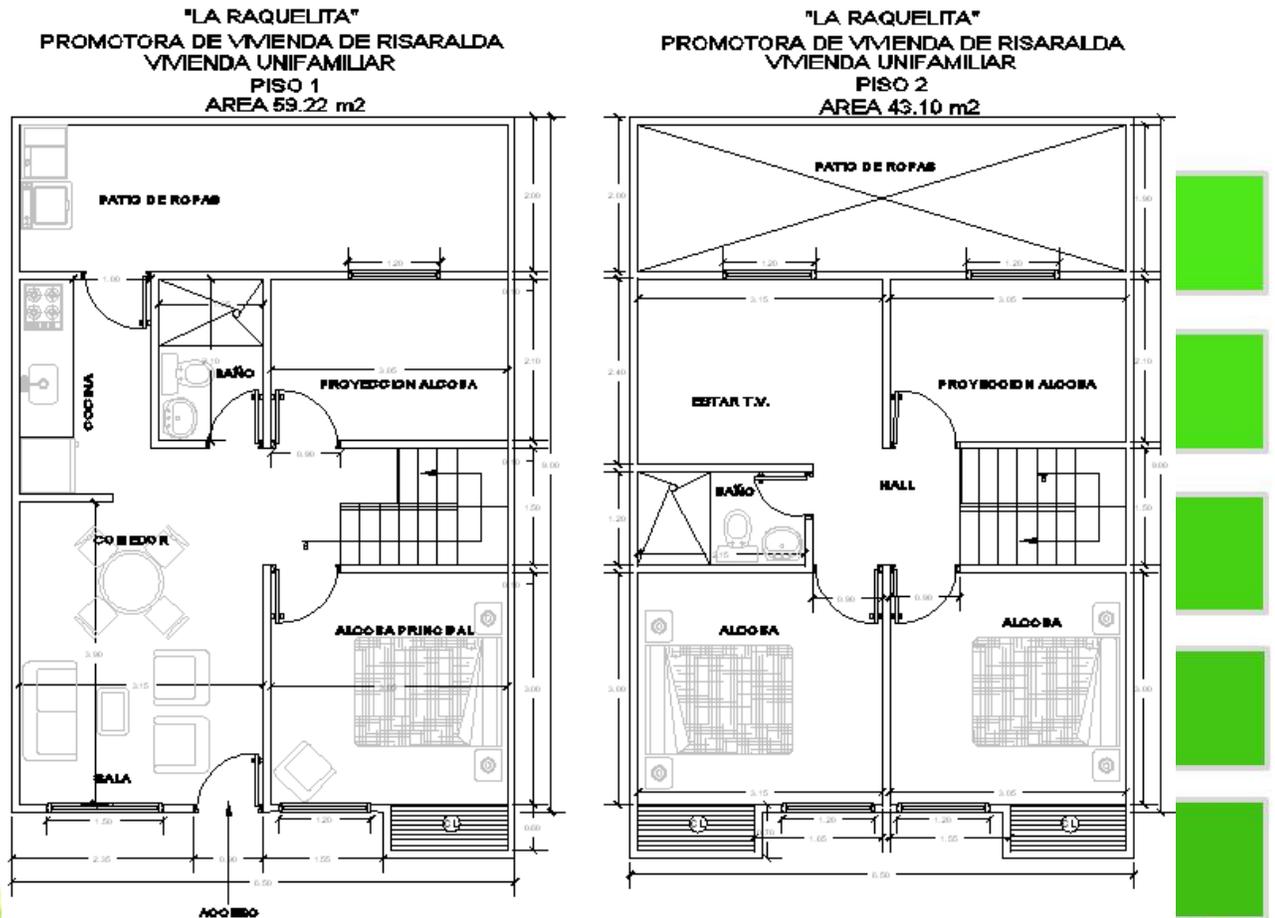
Planos Arquitectónicos Vivienda La Raquelita
